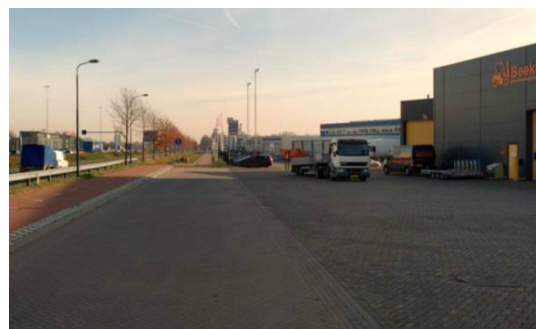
Tracé tussen het Ei van Drunen – Vimmerik
